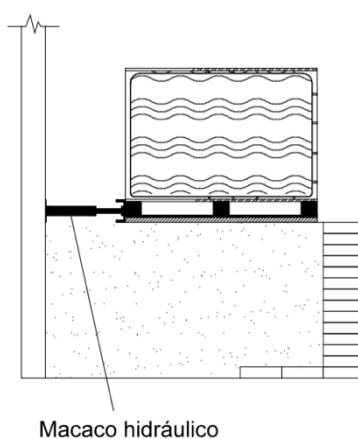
Esquema em corte do posicionamento do macaco hidráulico.
